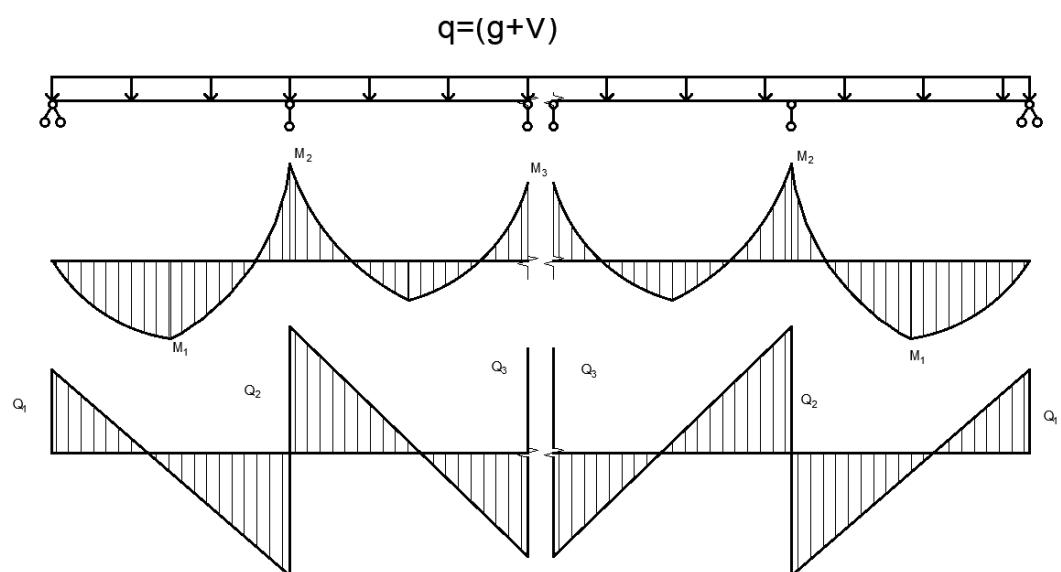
расчетная схема балки и эпюры поперечных сил и моментов
